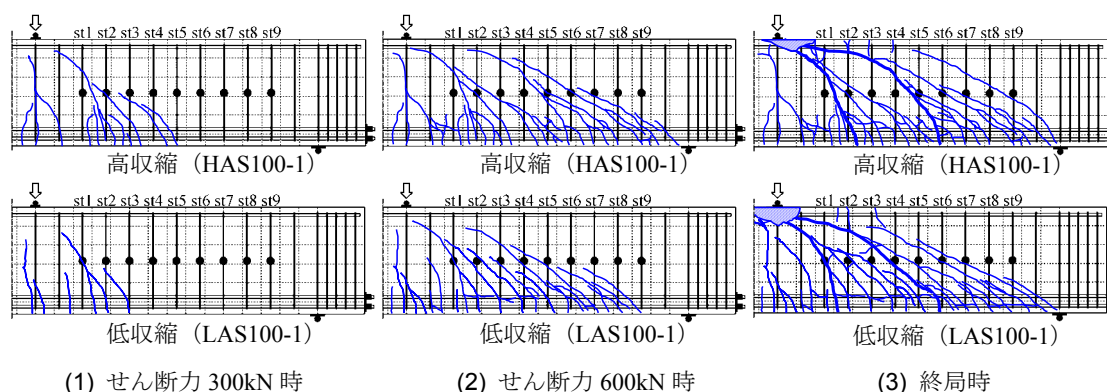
ひび割れ進展と破壊状況 (d=1000mm)
